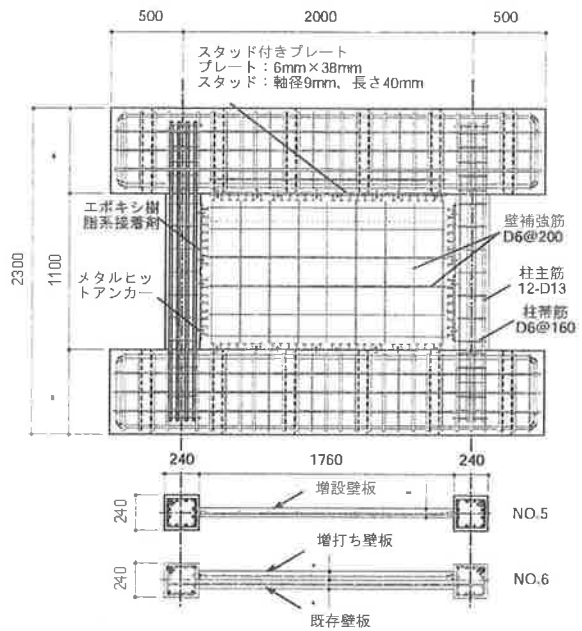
試験体の配筋詳細図例 (NO.5,NO.6)
